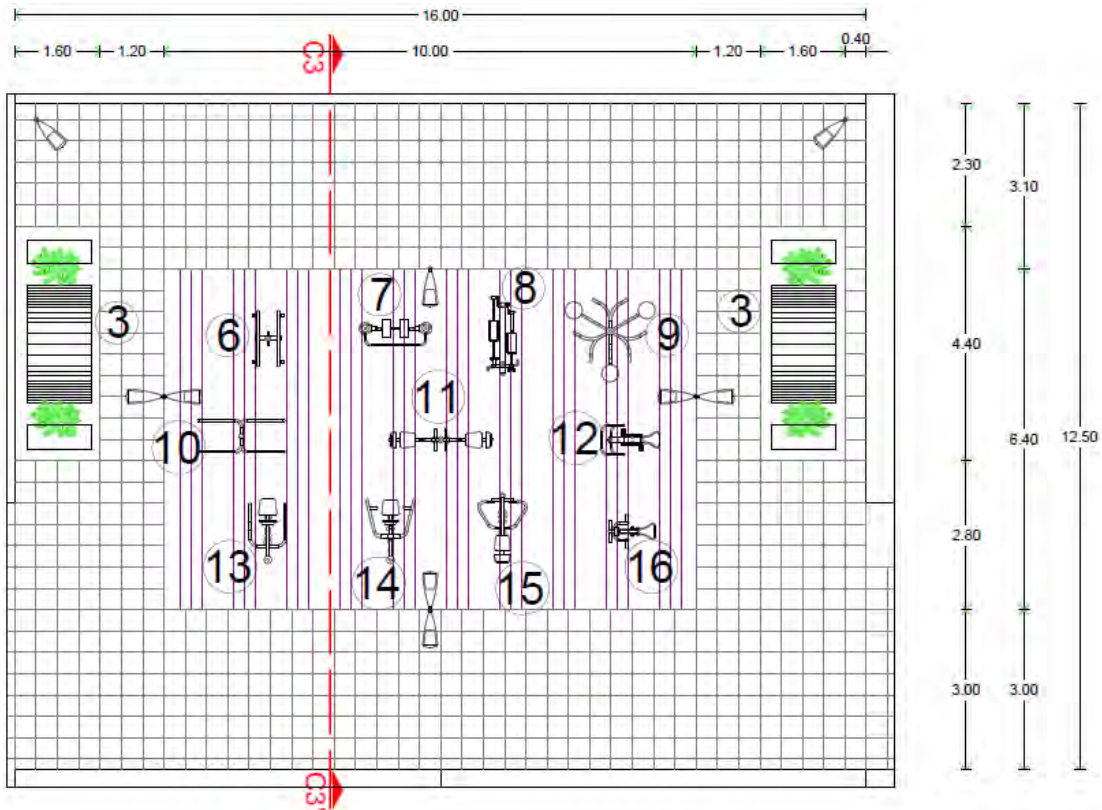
Planta arquitectónica de la plaza 3. Se muestra la diferencia de pavimentos y la ubicación de cada tipo de mobiliario.
